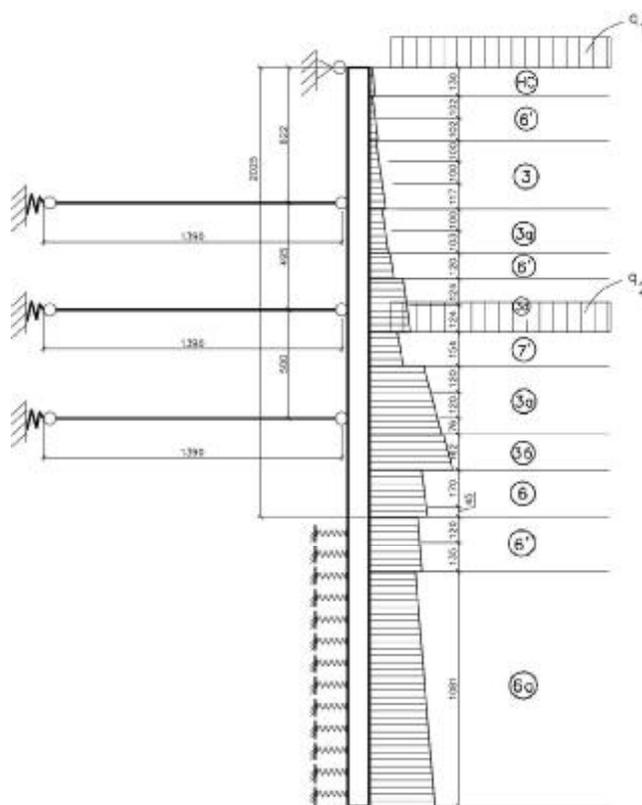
Расчетная схема ограждающей конструкции на 4 этапе разработки грунта
